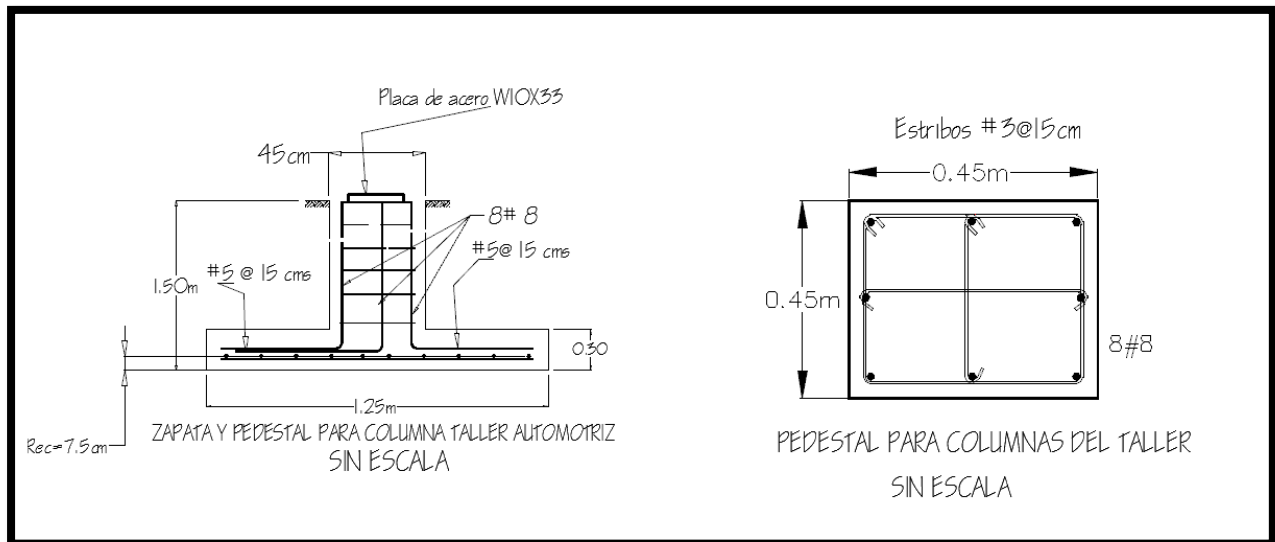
Perfil y vista en planta del pedestal y su distribucion del acero de refuerzo.
